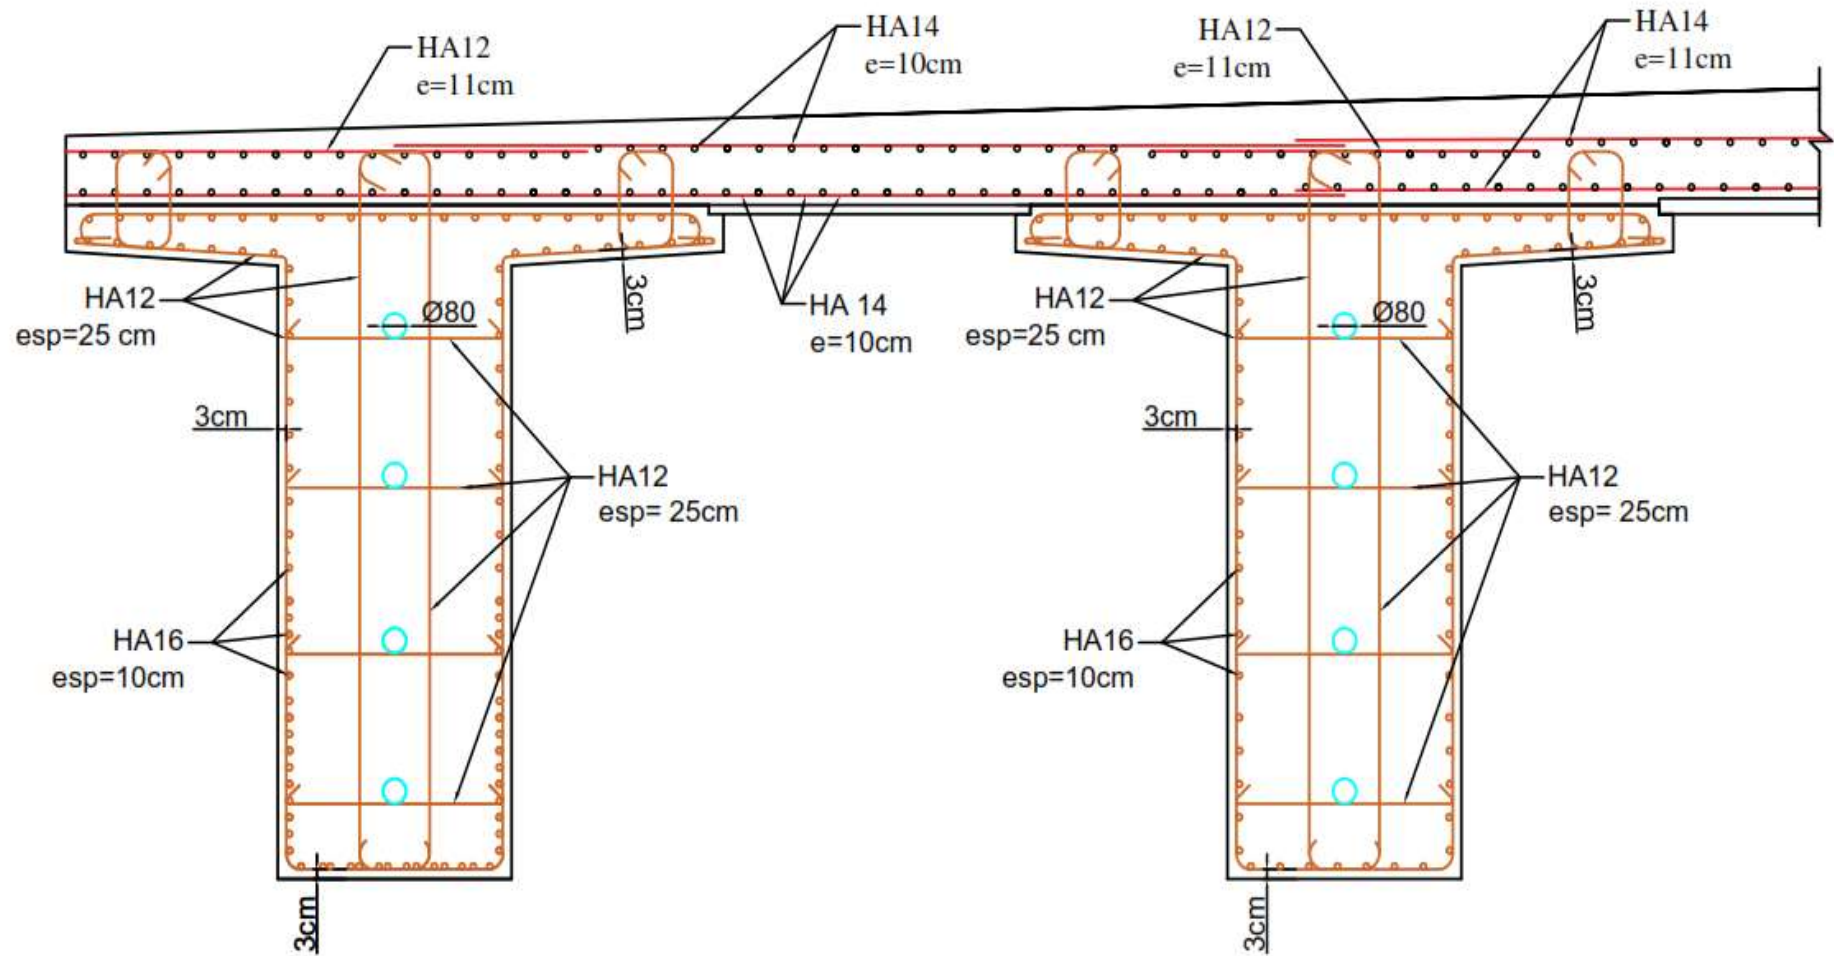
plan de ferrailage poutre + hourdis en section d'about
